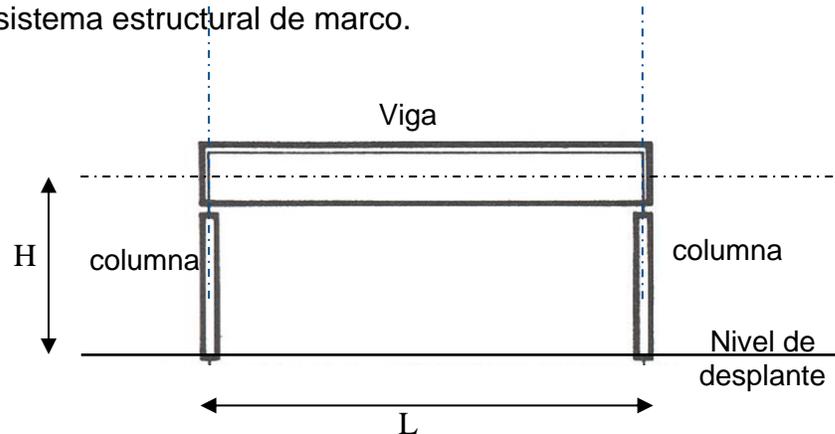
que muestra los elementos estructurales de un marco. (Imagen propia)
